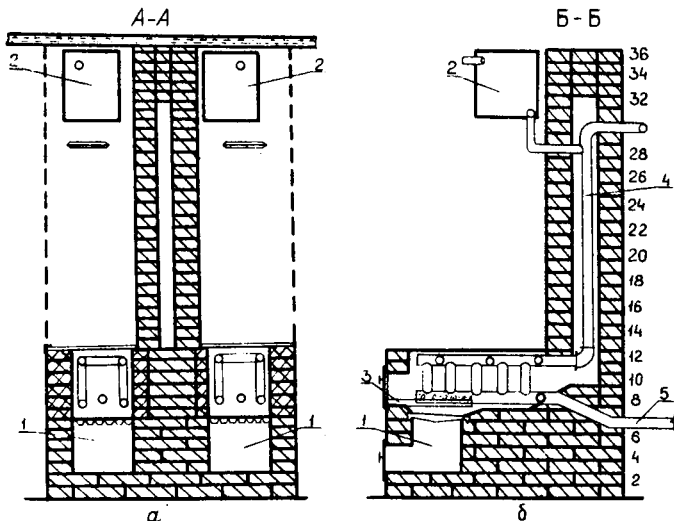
Печь отопительно-варочная № 10: а — разрез по линии А — А; б — разрез по линии Б — Б; 1 — камеры для воздуха под газовыми горелками; 2 — расширители; 3 — горелки; 4 — трубы горячей воды; 5 — трубы обратной воды
